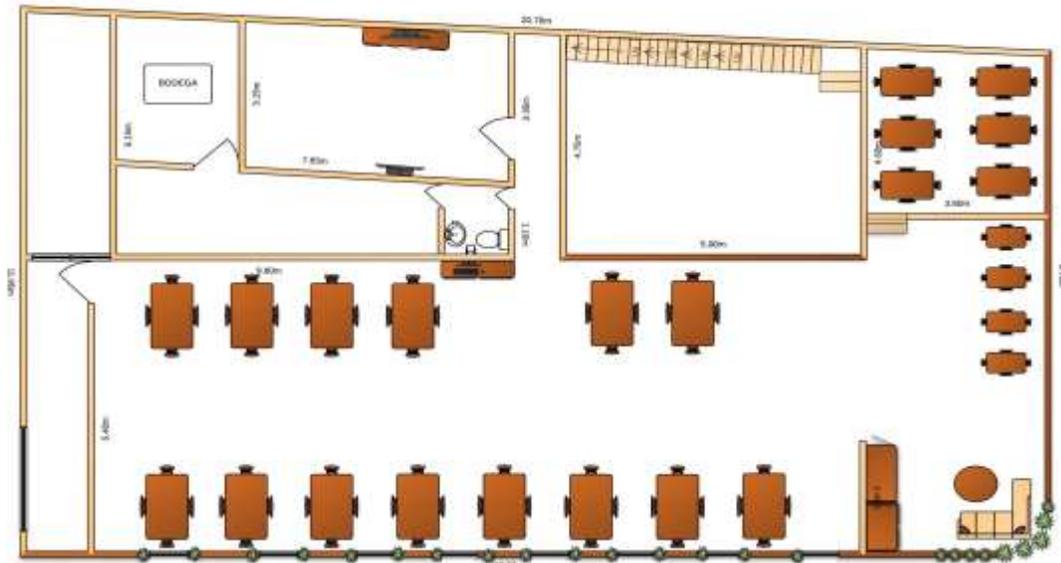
Distribución en planta propuesta para el Restaurante Simmer Down, segunda planta.
